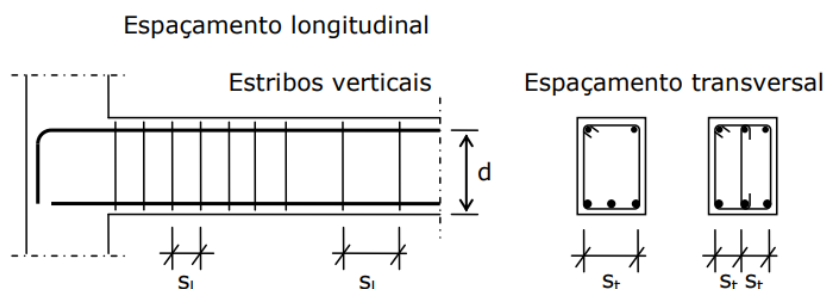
Espaceamento longitudinal e transversal das armaduras de esforço transversal. [5]
